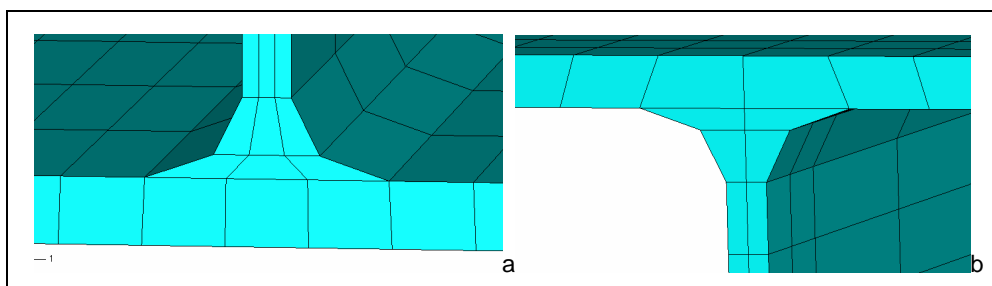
Representação do pormenor da ligação entre os banzos e a alma da viga (a) e da coluna (b).
